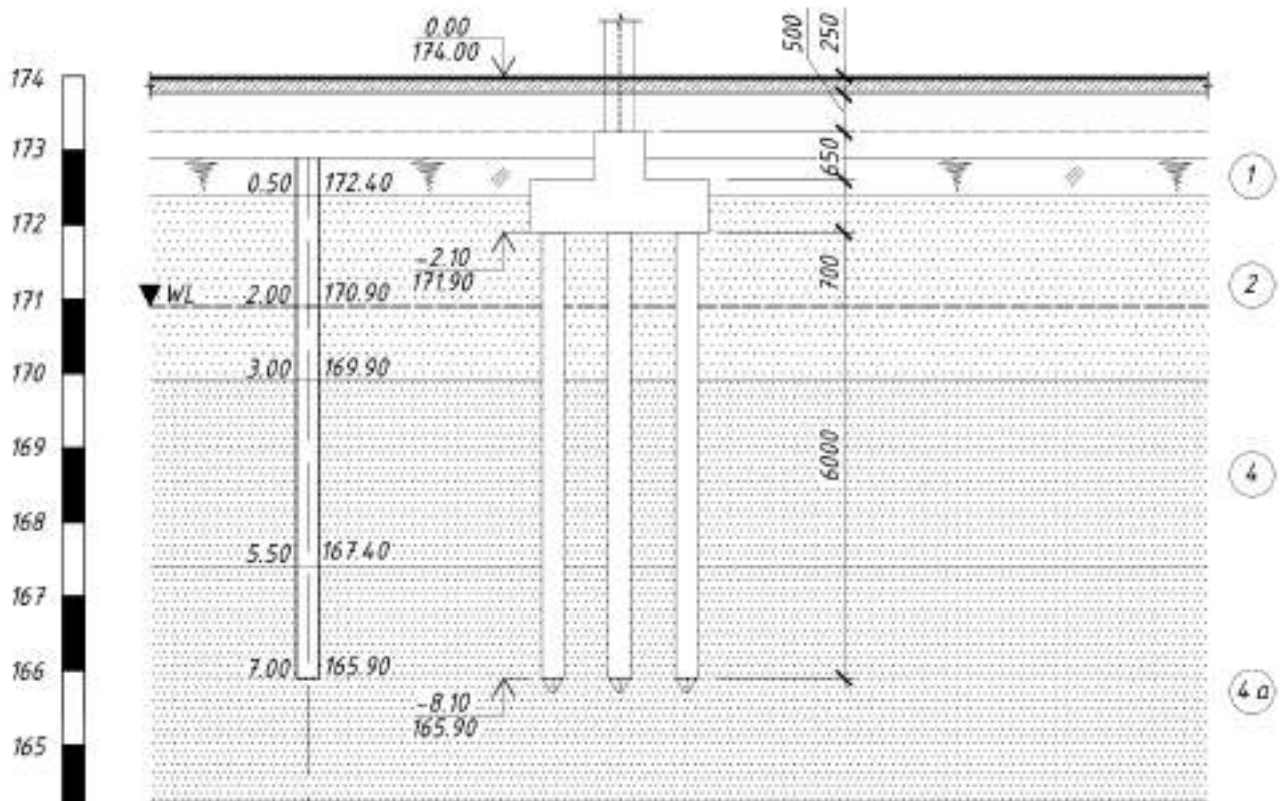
Орієнтовна схема посадки фундаменту на інженерно-геологічний розріз
